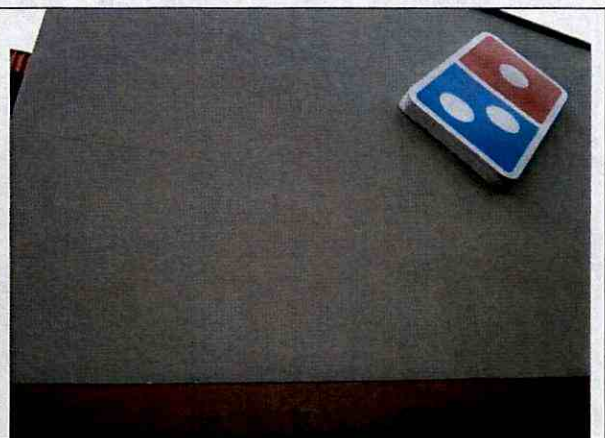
Fisuras en juntas de láminas de la fachada
